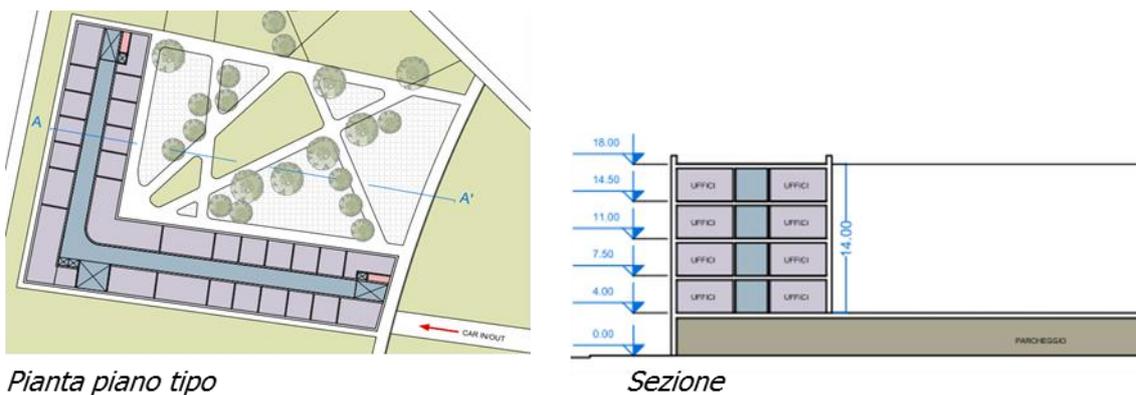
Edifici e spazi del connettivo del waterfront, pianta e sezione (Fonte: Masterplan, Schede Interventi – Scheda 2.10 e 2.11)
